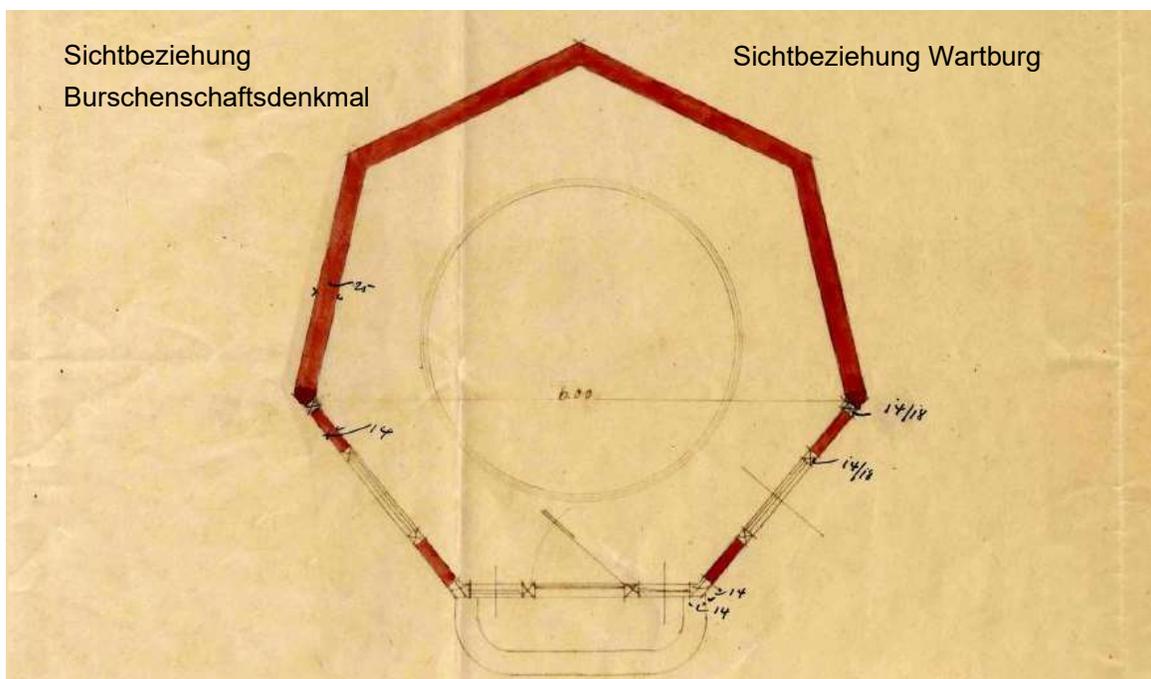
Grundriss des Teepavillons aus Bertrams Schauplan von 1902, Quelle: Bertram M. (o. D.) zur Verfügung gestellt von Dr. Döll, S. (2024)
